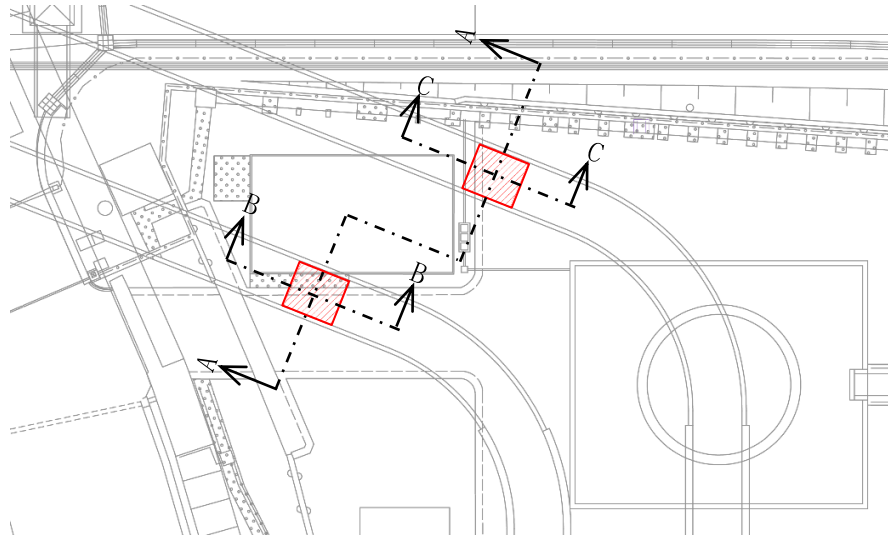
(1) 取放水路流路縮小工（第1号機取水路）(No. 1), (No. 2) 平面図
